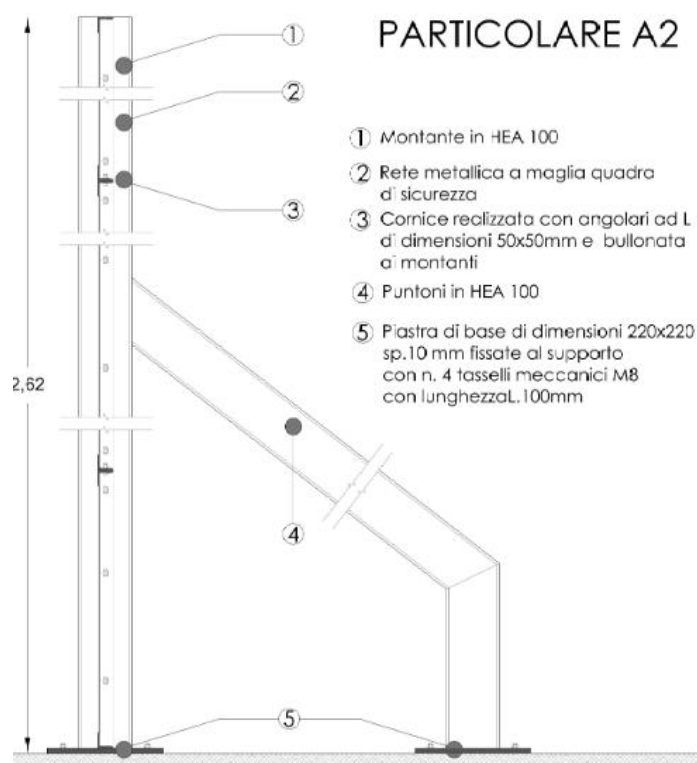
Particolare chiusura per protezione laterale Led Wall.
